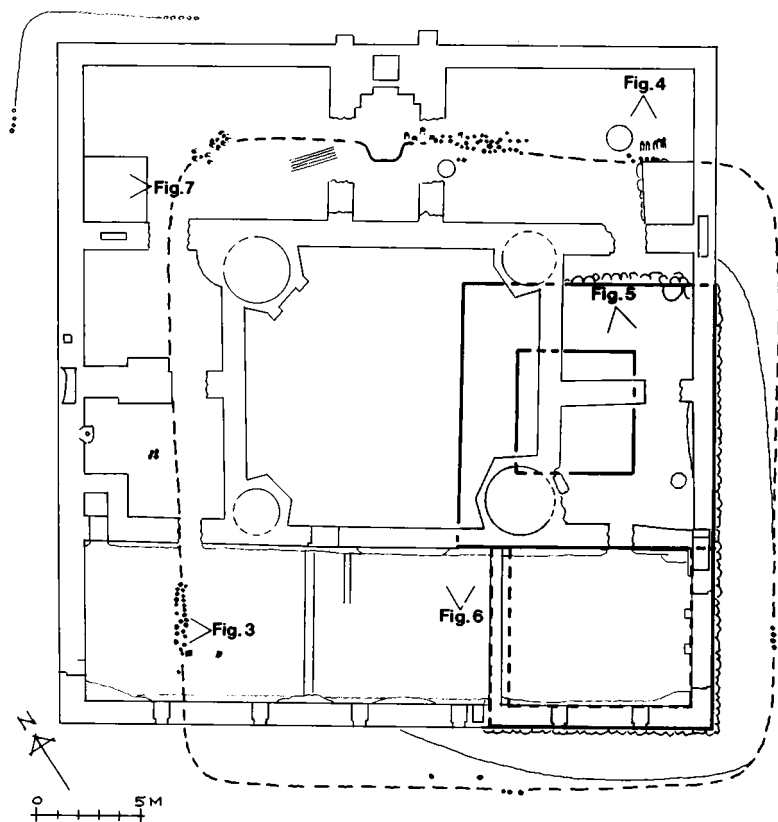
Plan over de udgravede rester af det middelalderlige Trøjborg. Indtegnet på plan af slotsruinen. Tænkte forløb vist med brudt linie.
